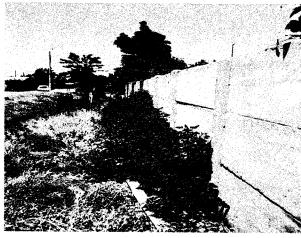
y 60: Fisuras en muro medianero
